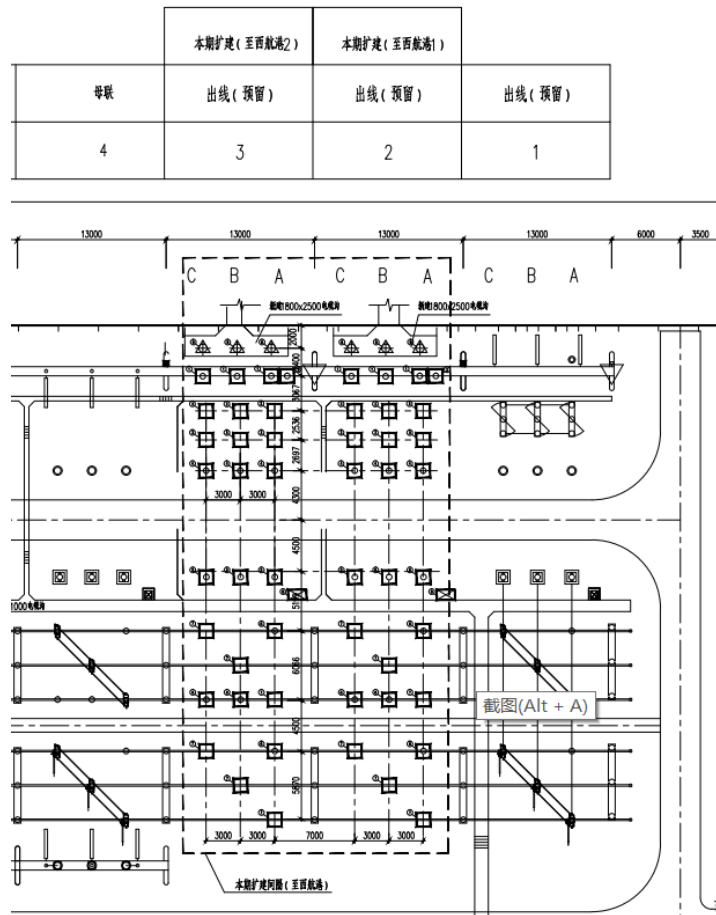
长顺 220 千伏变电站间隔扩建工程平面图
